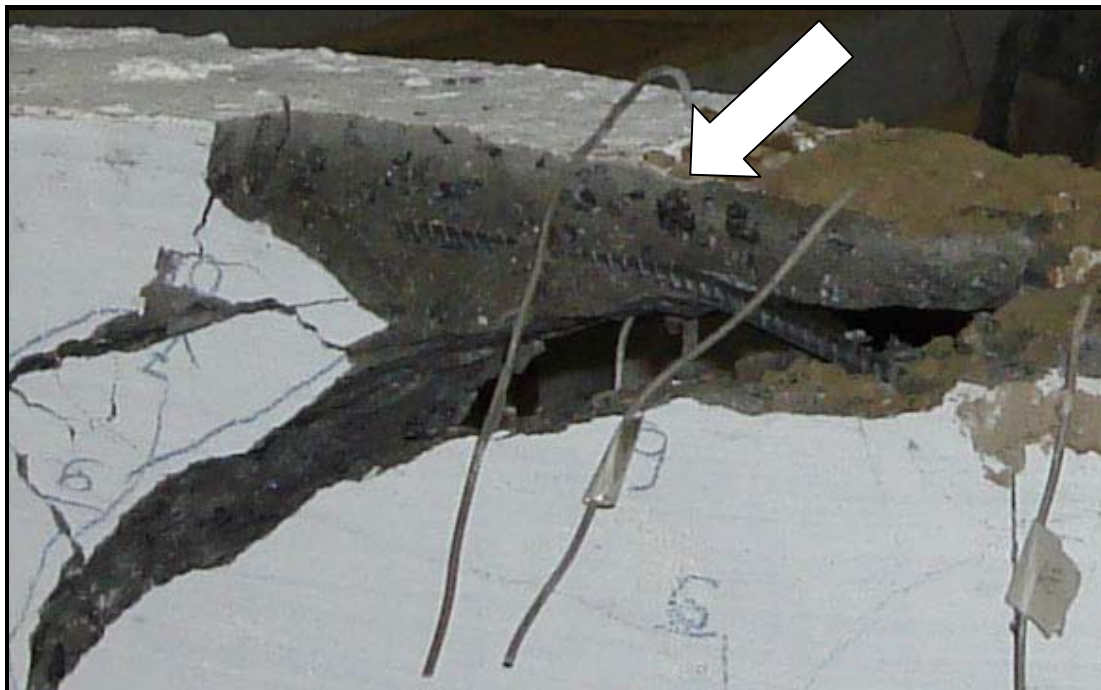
Padrão de fissuração para viga com armadura transversal
